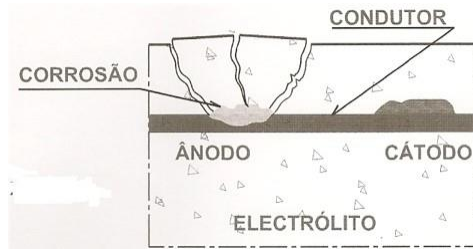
Processo eletroquímico de corrosão das armaduras do betão.
